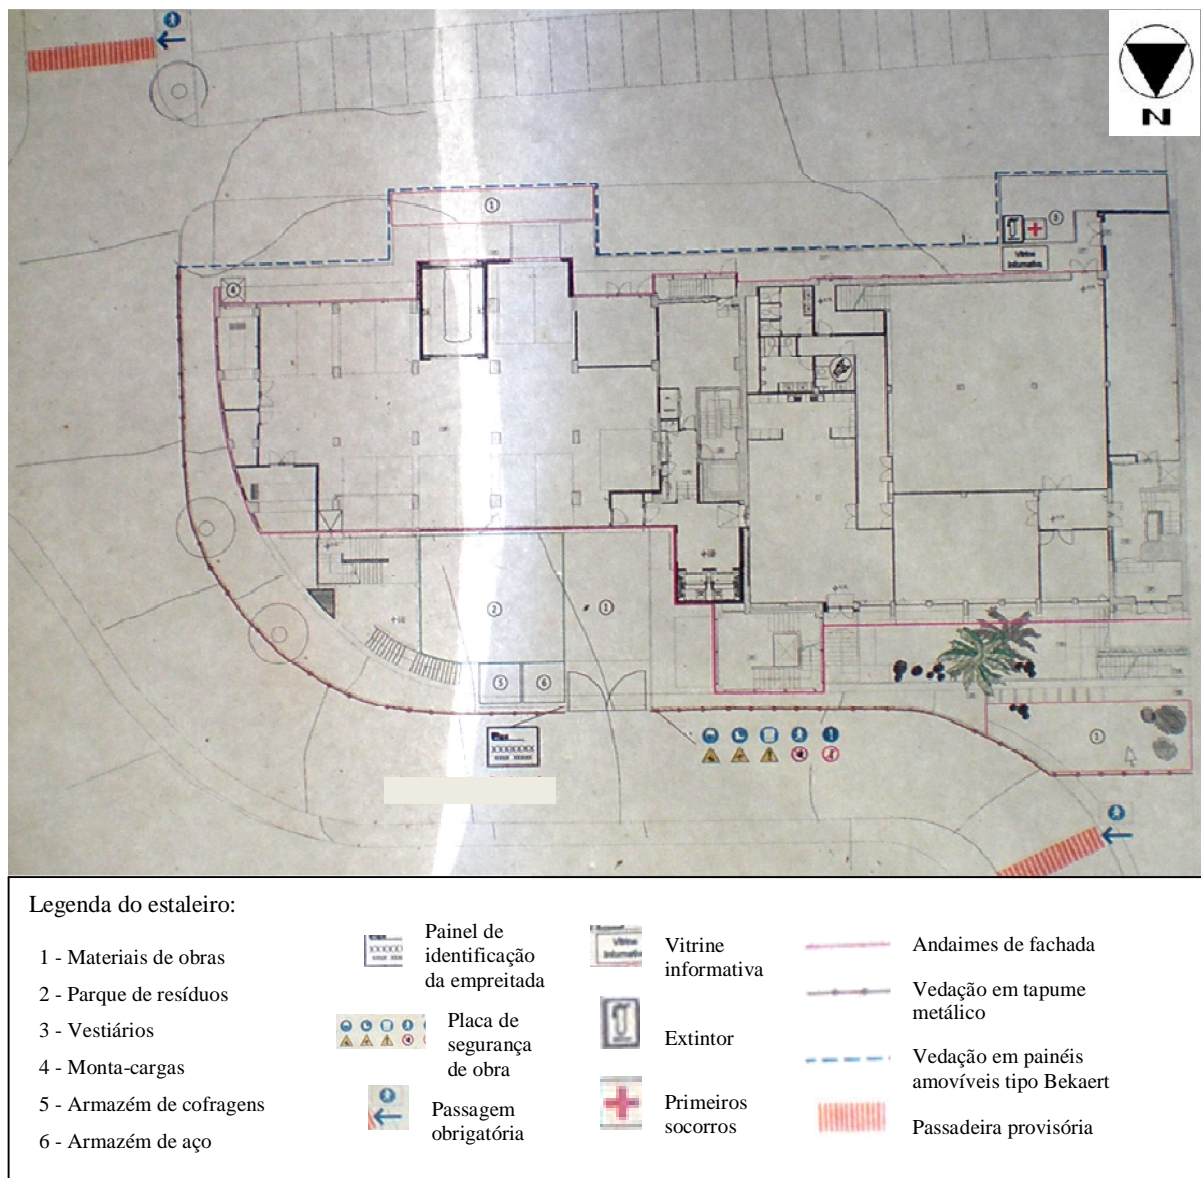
Planta de estaleiro da obra C (sem Escala).
